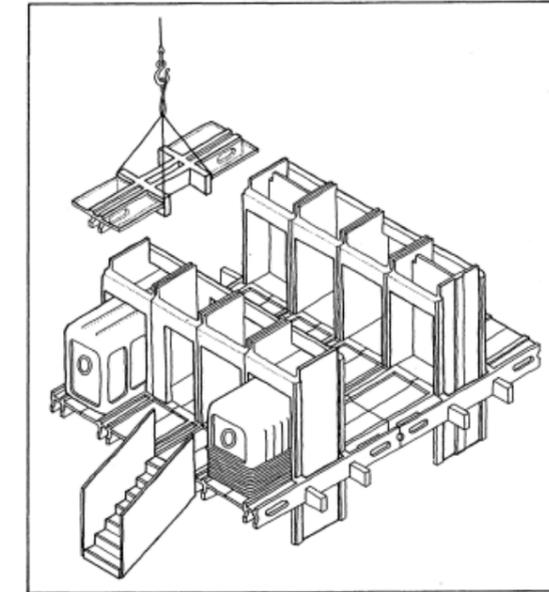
, REFACTURED APARTMENT HOUSE. KISHO KUROKAWA, 1962.
